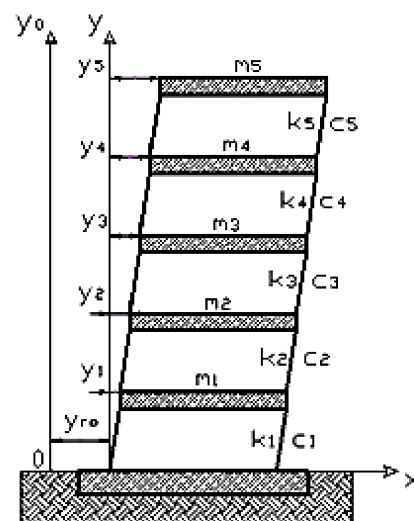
Расчетная схема здания с жестким защемлением с грунтом в плоскости
